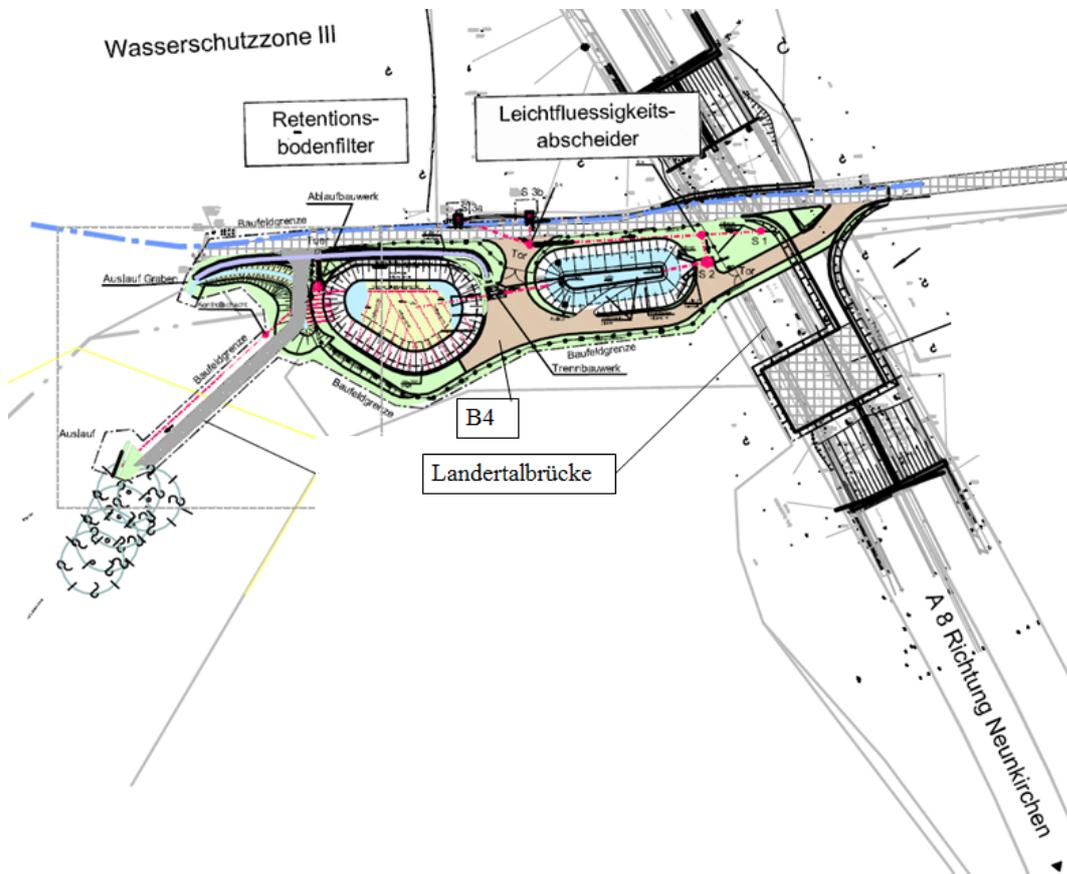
Übersicht vorh. Regenwasserbehandlungsanlage an der Landertalbrücke
